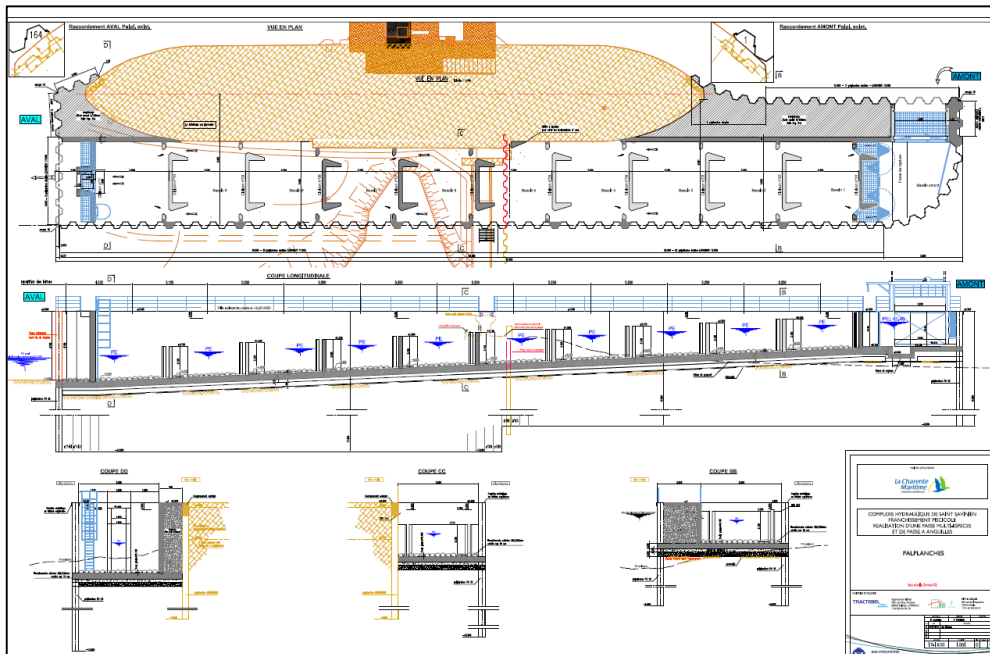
Plan en coupe longitudinale de la passe multispécifique (AVP)
